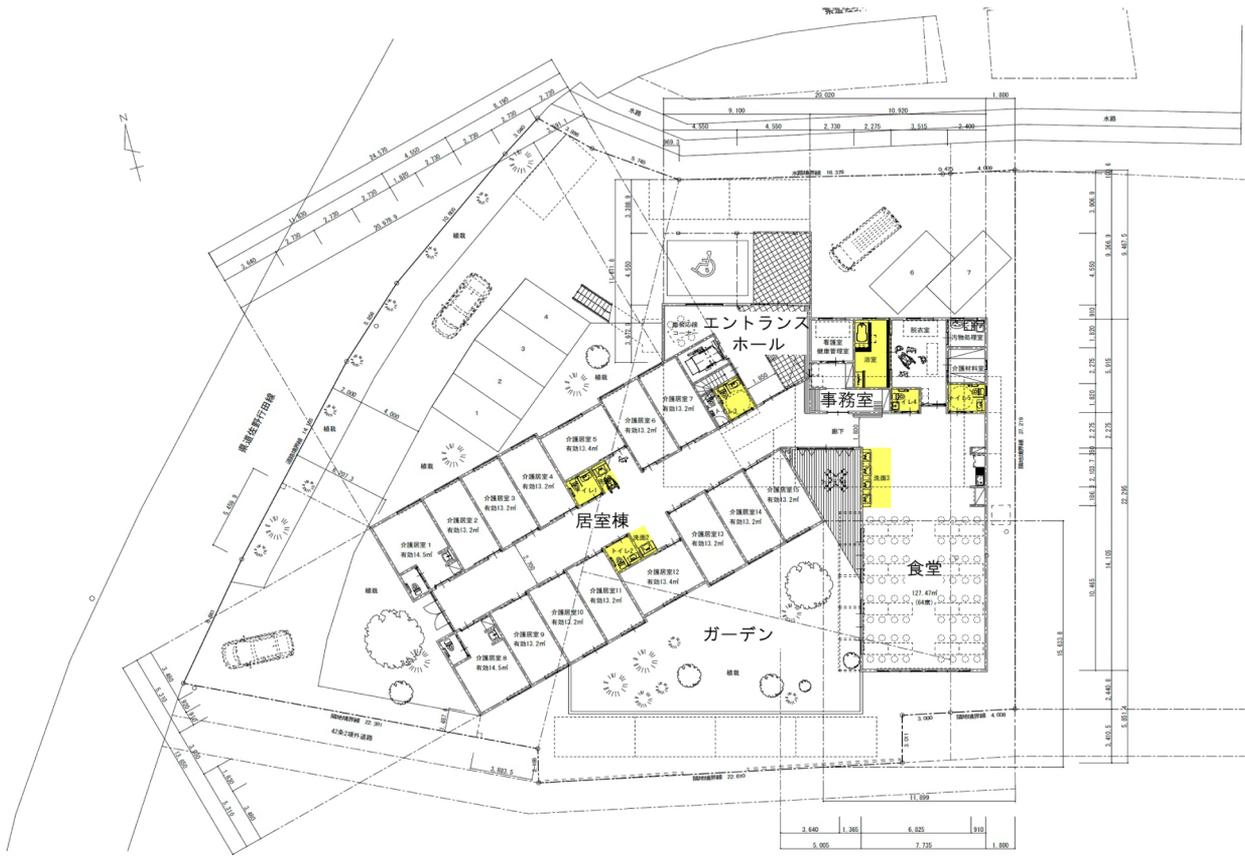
増築棟1階平面図 (基本設計案 2021.06.15)
